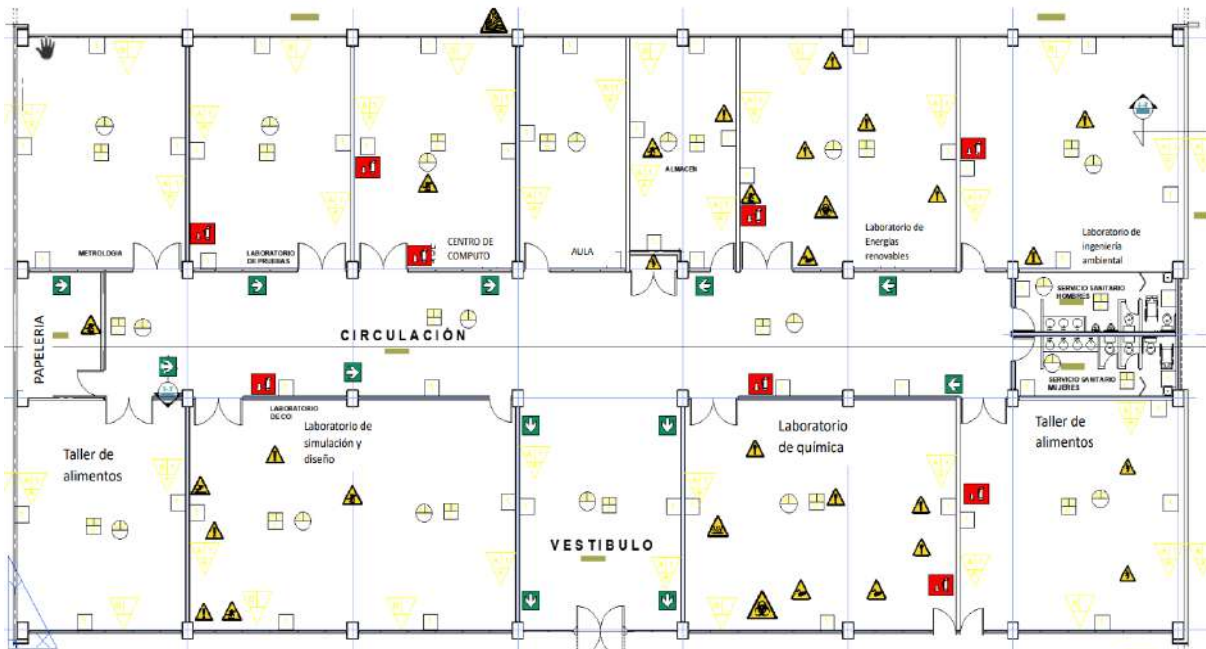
Plano edificio de laboratorios, Fuente (Canchola & Vela, 2023)
